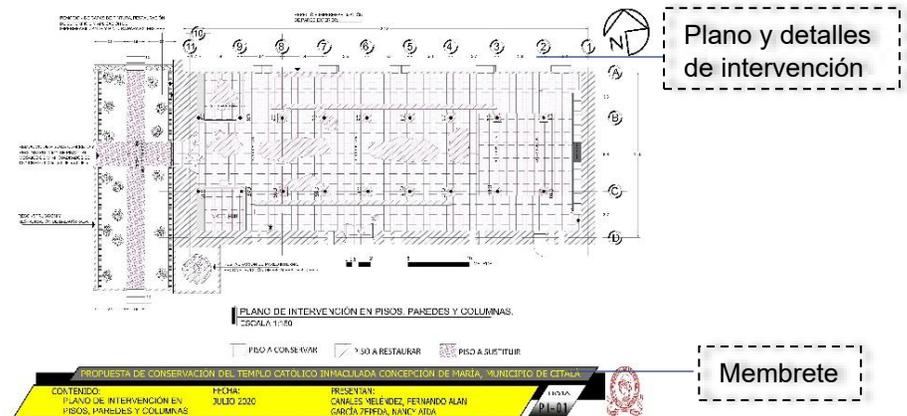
Modelo de planos de intervención. Fuente: elaboración propia
